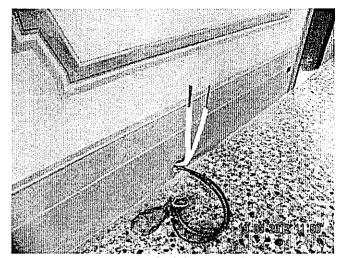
Stanza 1.5 (sala)- Particolare impianti posati
